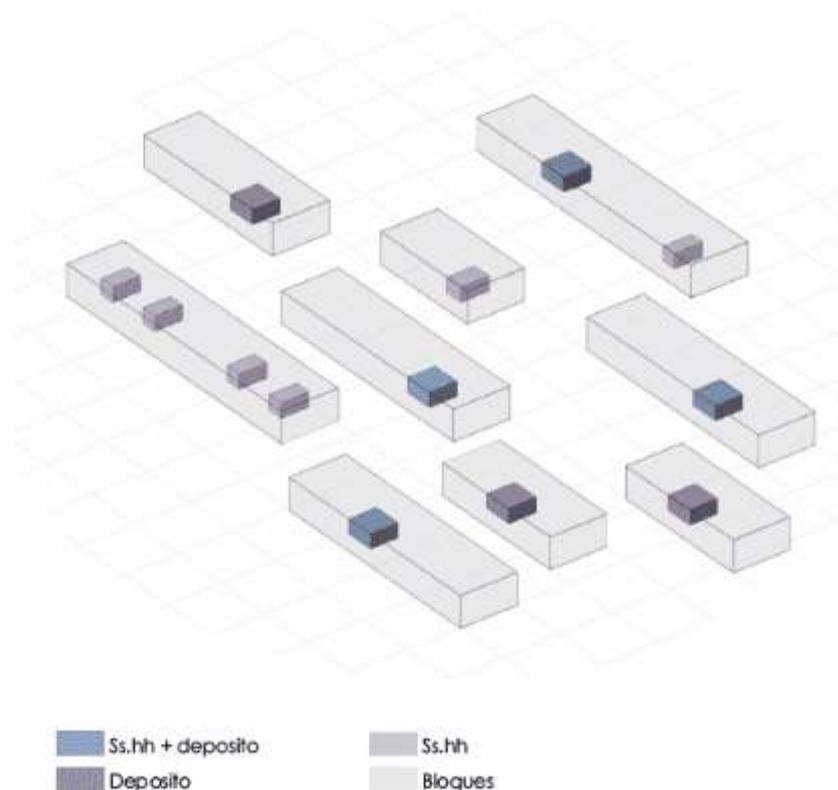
Empaquetamiento. Fuente: Elaboración propia
